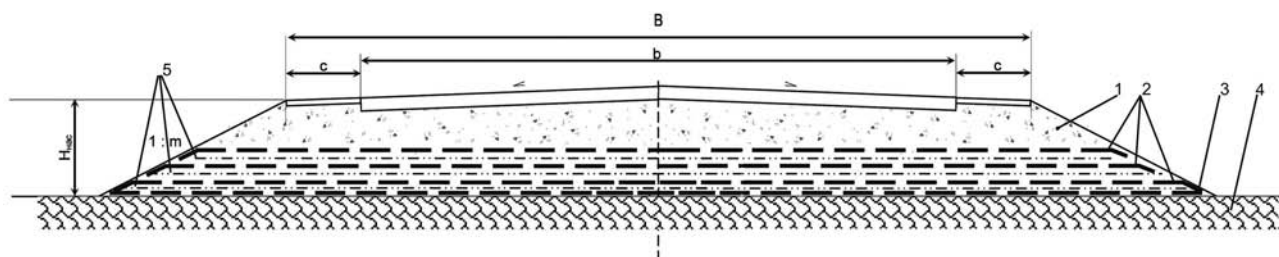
Конструкция на слабом основании с армирующими прослойками (слоями) из геосетки ПолиЭф® в основании насыпи: 1 - переходный слой; 2 - прослойка из ПолиЭф; 3 - прослойка из геотекстиля; 4 - слабое основание; 5 - связный грунт
